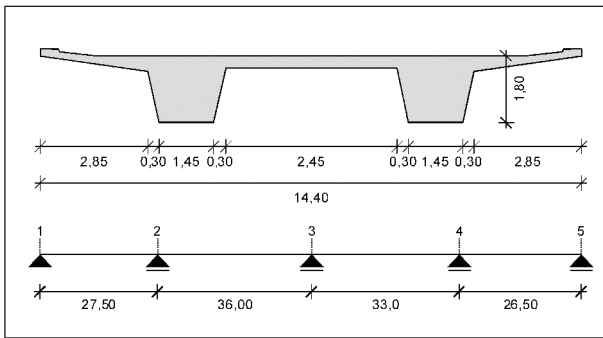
2-stufiger Plattenbalken im Bemessungsschnitt und statisches System in Längsrichtung für Brücke 3
